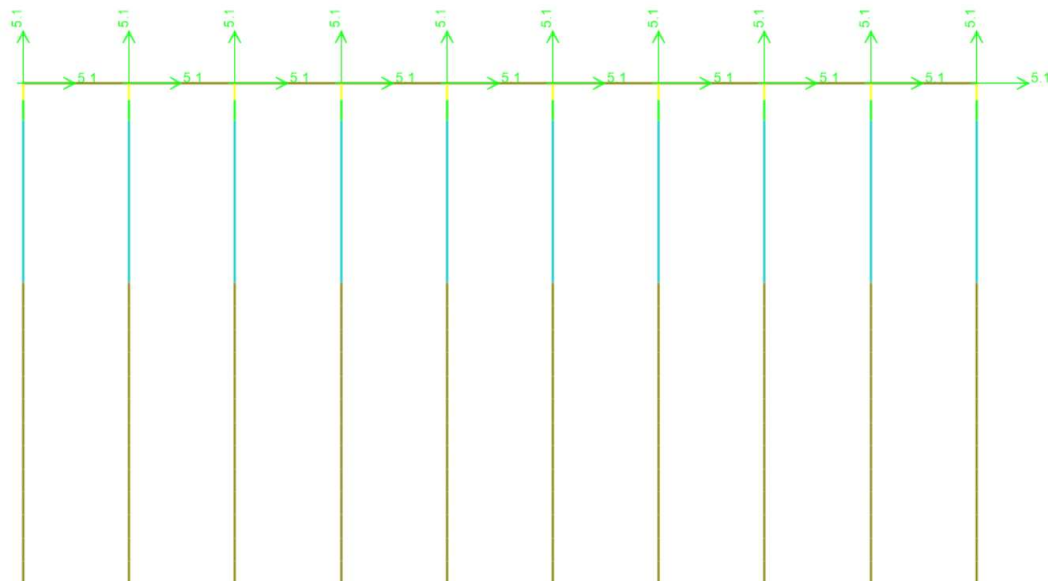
Joint Masses de pilotes verticales - Eje D (5.10 kN-s²/m)
